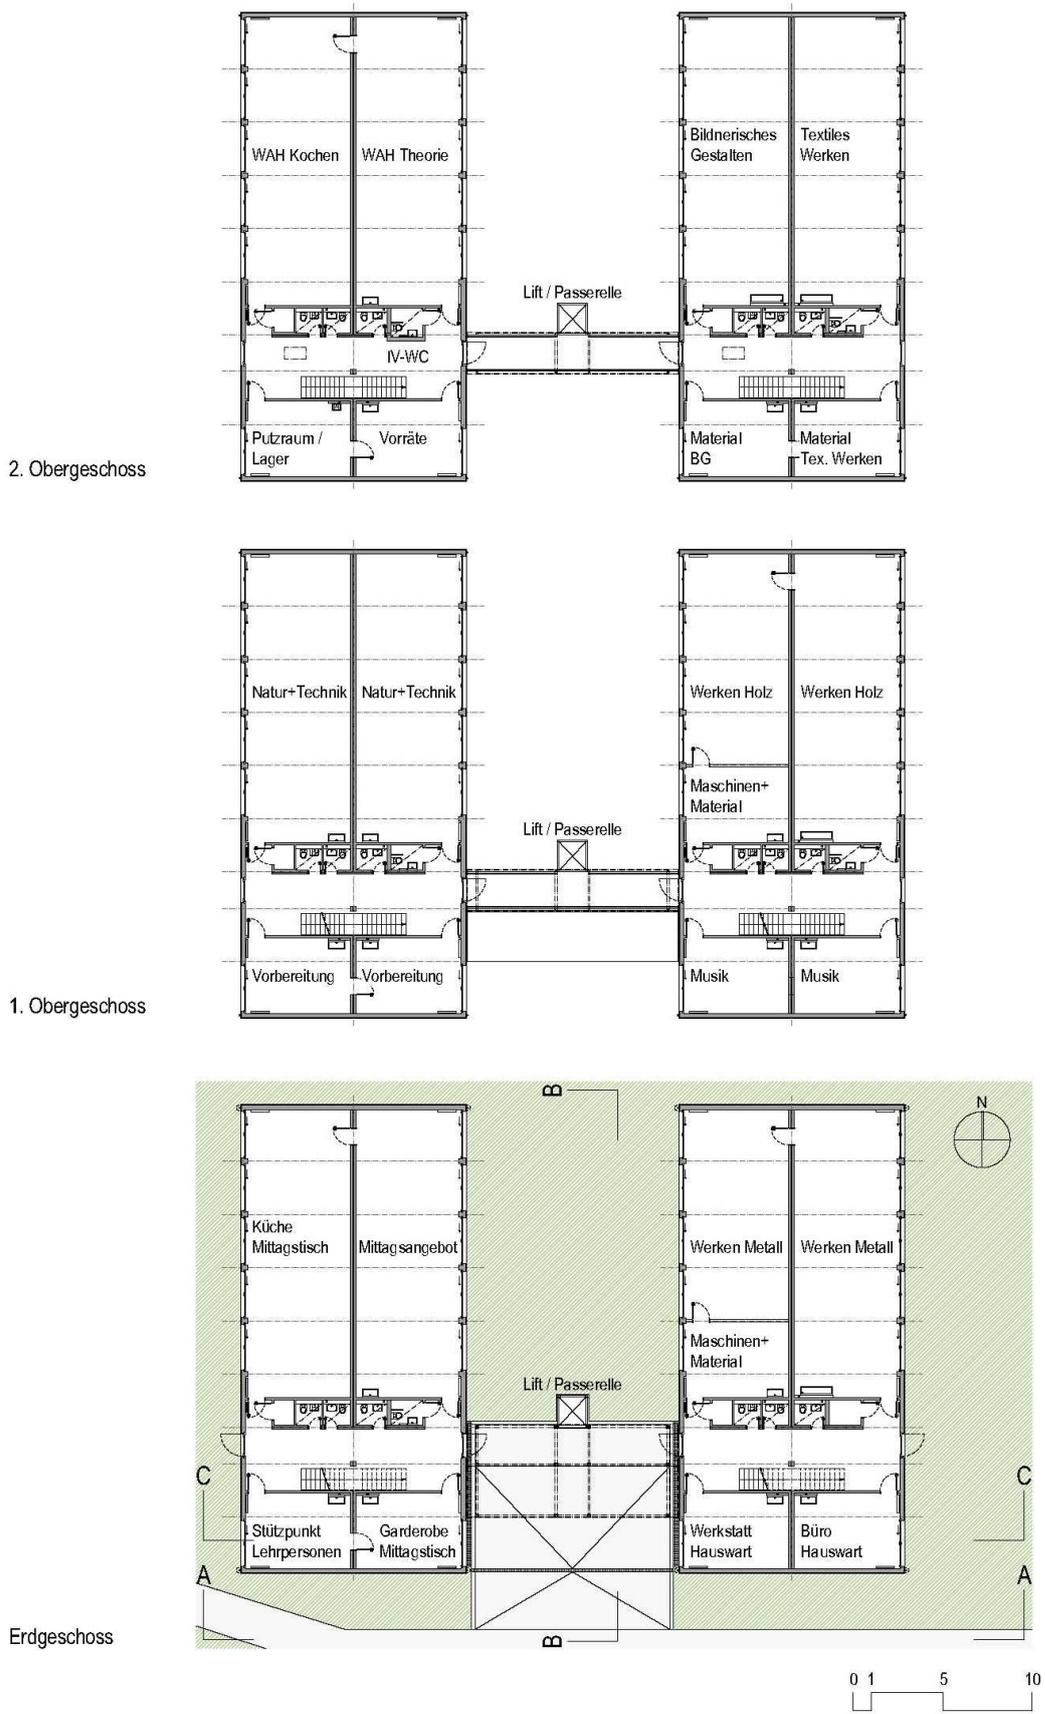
Grundrisse der Holzmodulbauten nach Anpassung der Raumgrößen und mit neuer Nutzung
